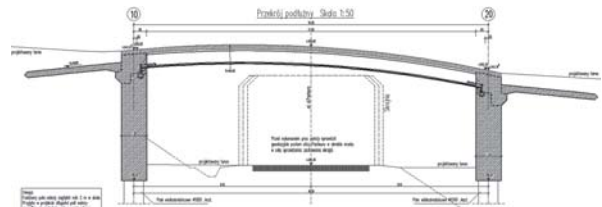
Wiadukt drogowy w Vigaun – przekrój poprzeczny
